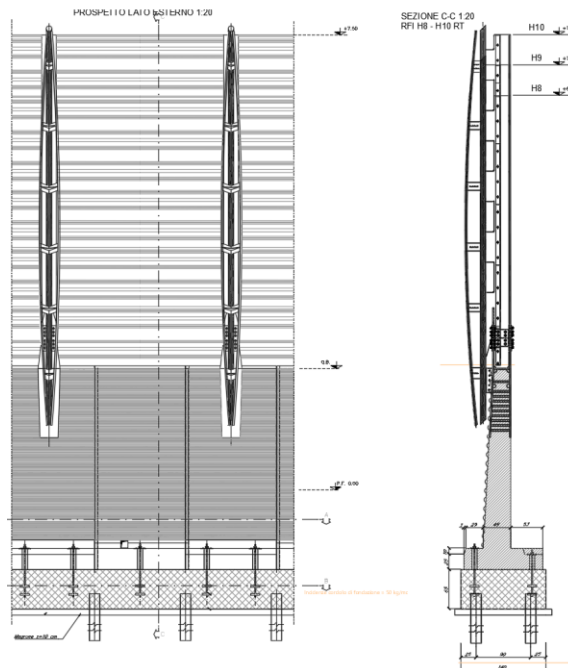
Prospetto e sezioni tipo barriere antirumore tipo H10
